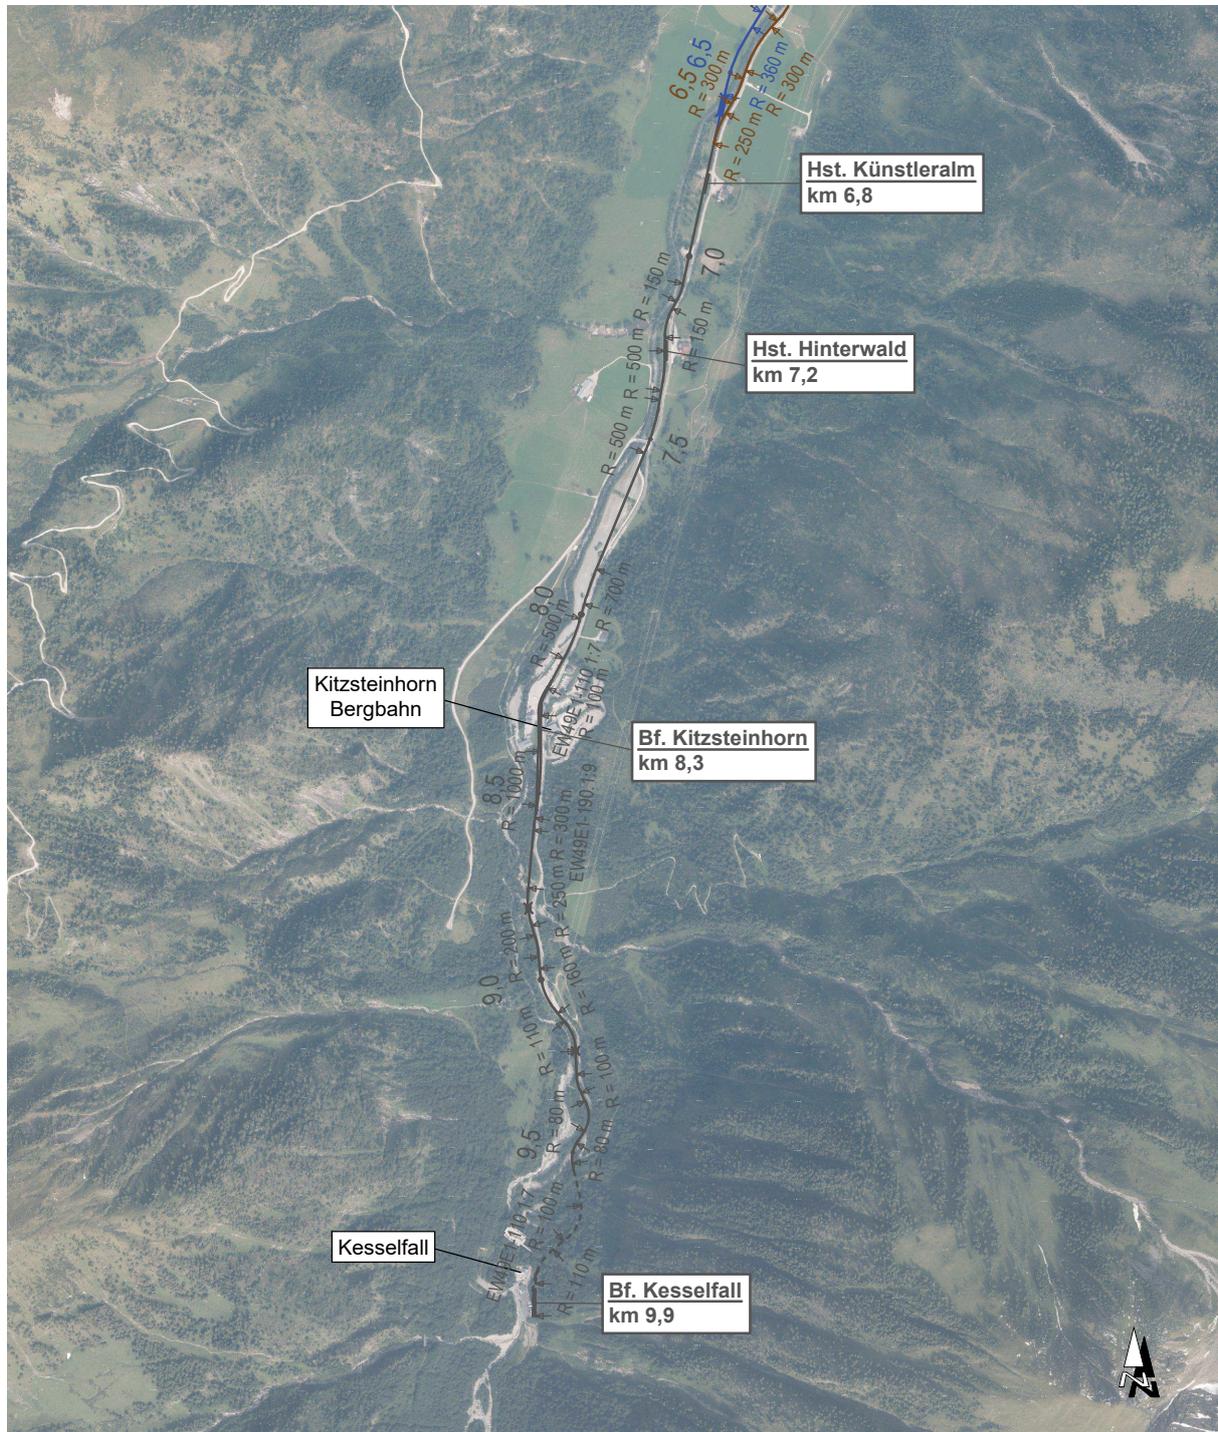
Lageplan der Variante 3 (M = 1:20000)
